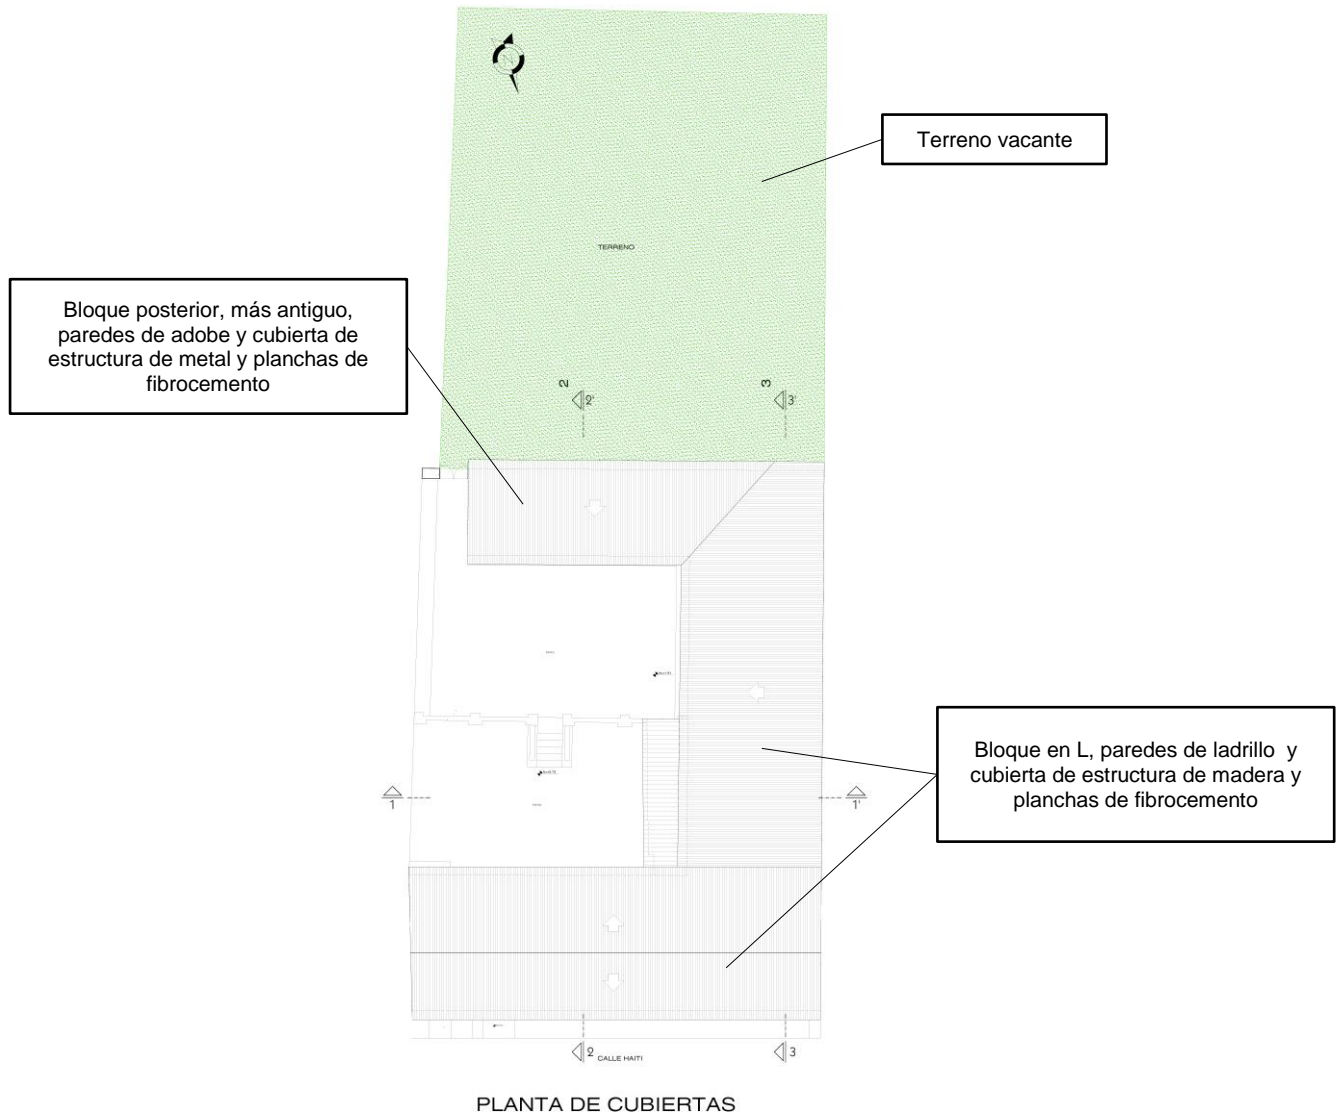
Planta de cubiertas inmueble existente, Elaborado por (Cabezas I., 2017)
